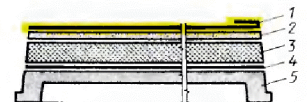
Конструкция промышленной безрулонной железобетонной крыши для крупнопанельных жилых домов:
